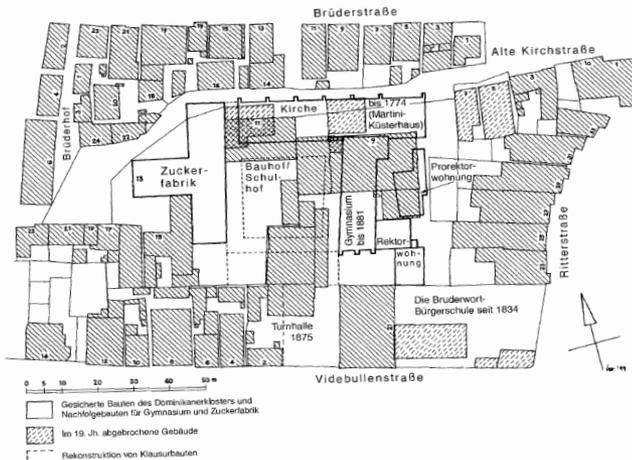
Alte Kirchstraße 9-15, ehemaliges Dominikanerkloster, Lageplan der Baugruppe innerhalb der heutigen Bebauung.
